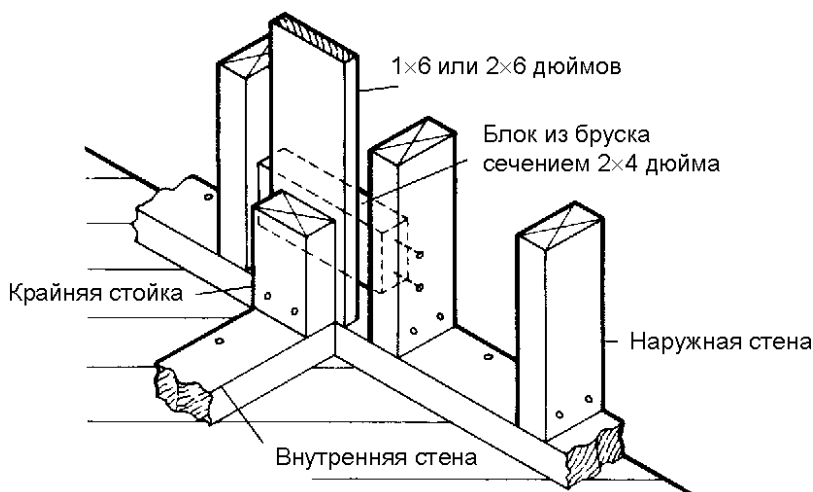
Второй способ крепления перегородок к наружным стенам (Forest Products Laboratory)
